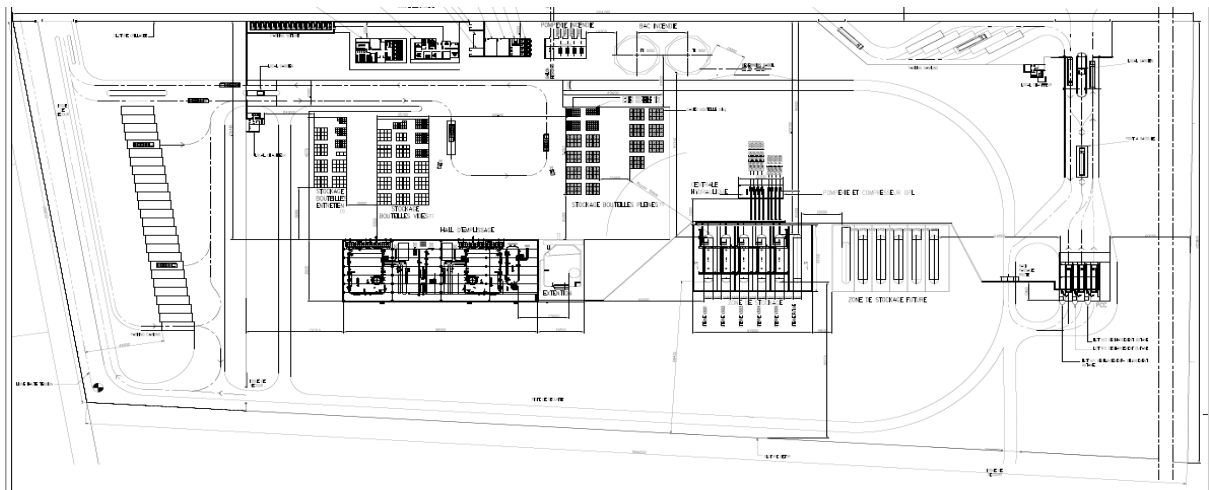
Plan d'ensemble du Centre Emplisseur de Massa – Agadir
